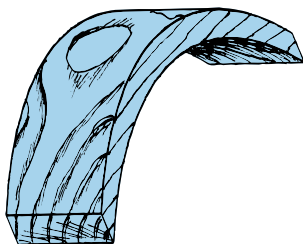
Pièce massive simple. Assemblage en coupe de pierre
